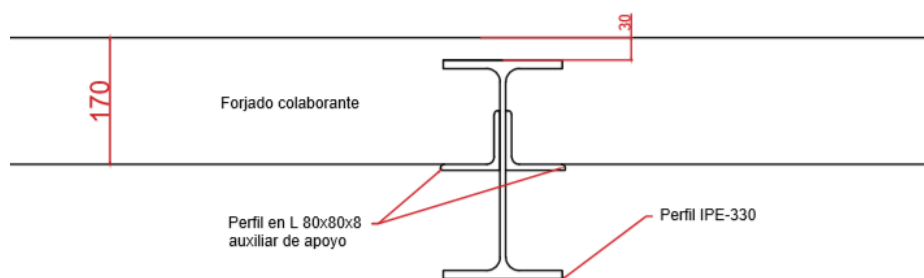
Detalle disposición de perfiles auxiliares de apoyo.
